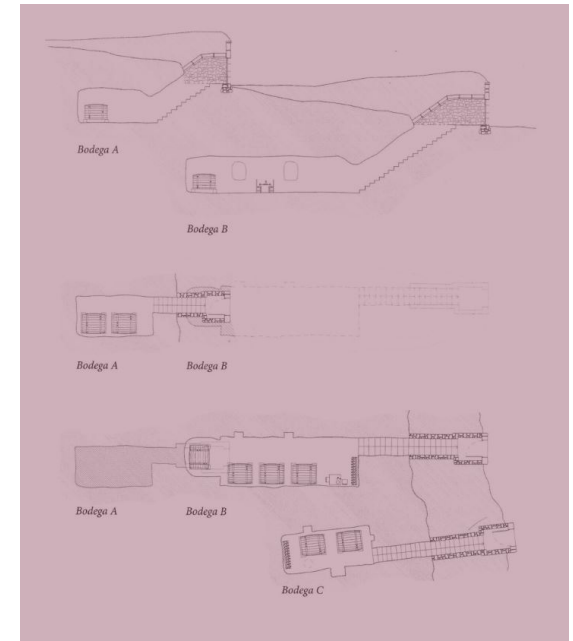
Esquema de dos bodegas excavadas superpuestas en pendiente. (Fuente: Jové, 2021).
